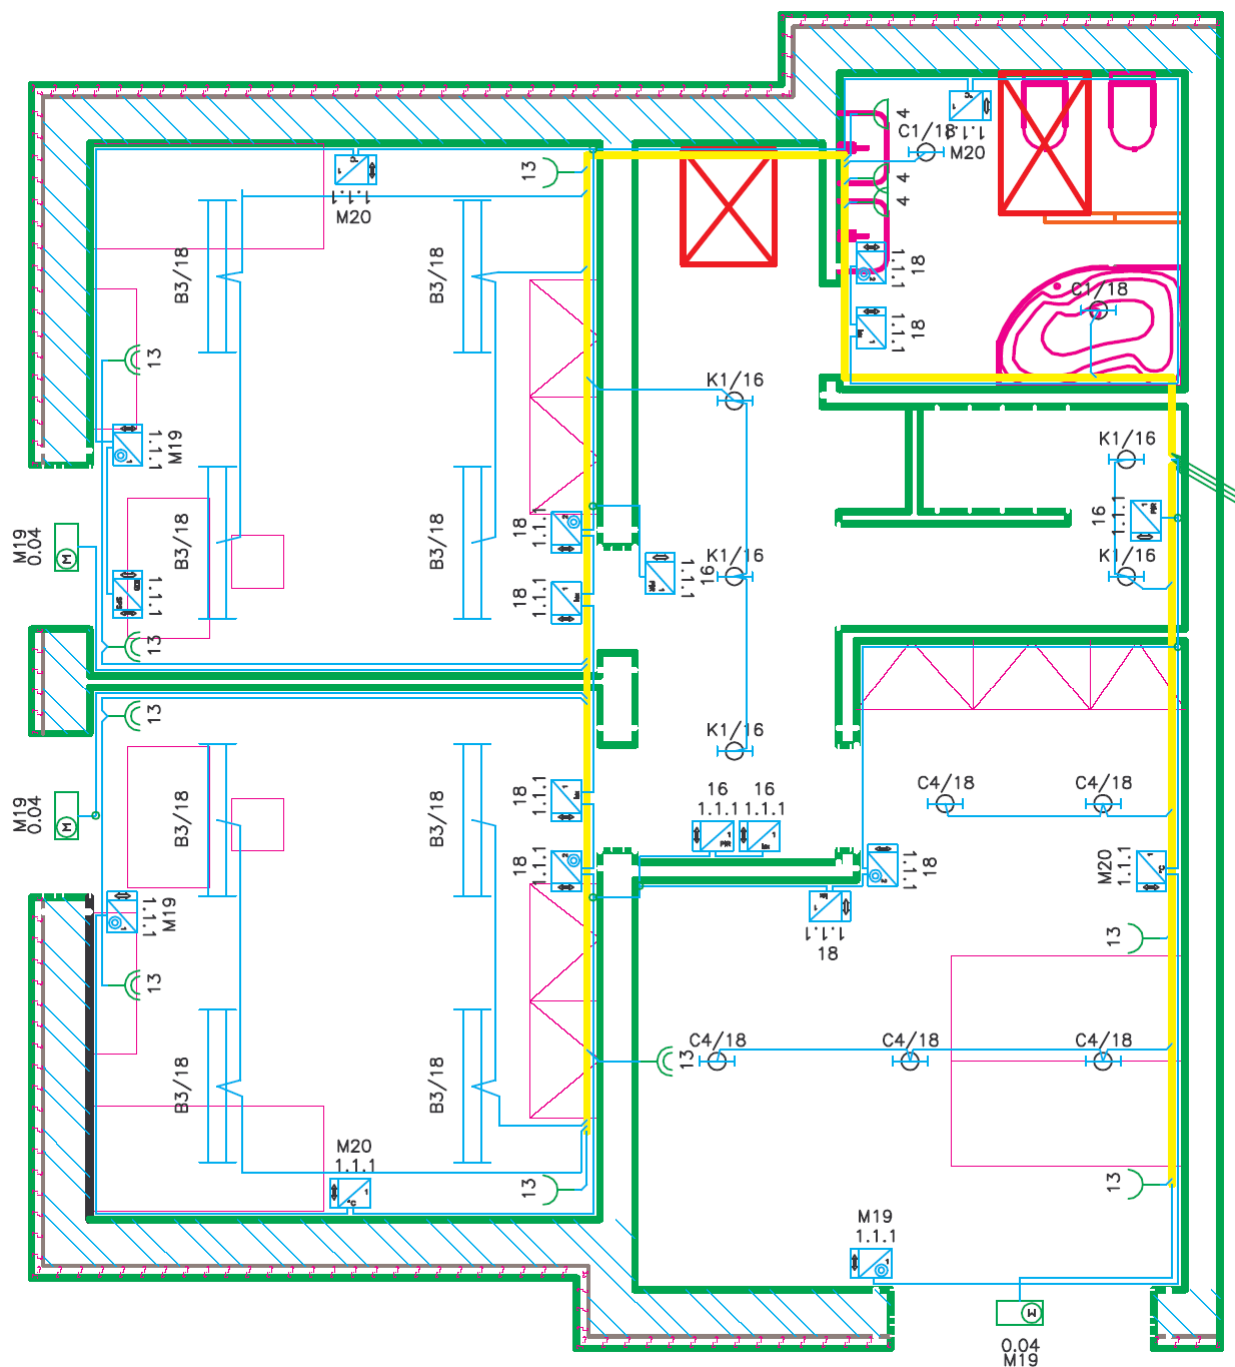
Projekt B. – situační schéma půdorysu prvního patra.
